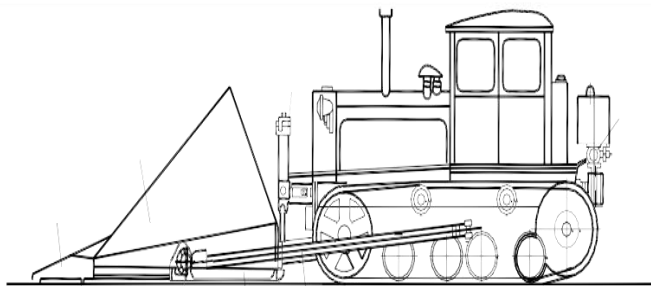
Кусторез – КБ 2.8 для подготовительных работ: 1 – колун; 2 – отвал; 3 – гидроцилиндр; 4 – гидропривод; 5 – лопаты; 6 – толкающая рама; 7 – лыжа; 8 – нижняя рама
